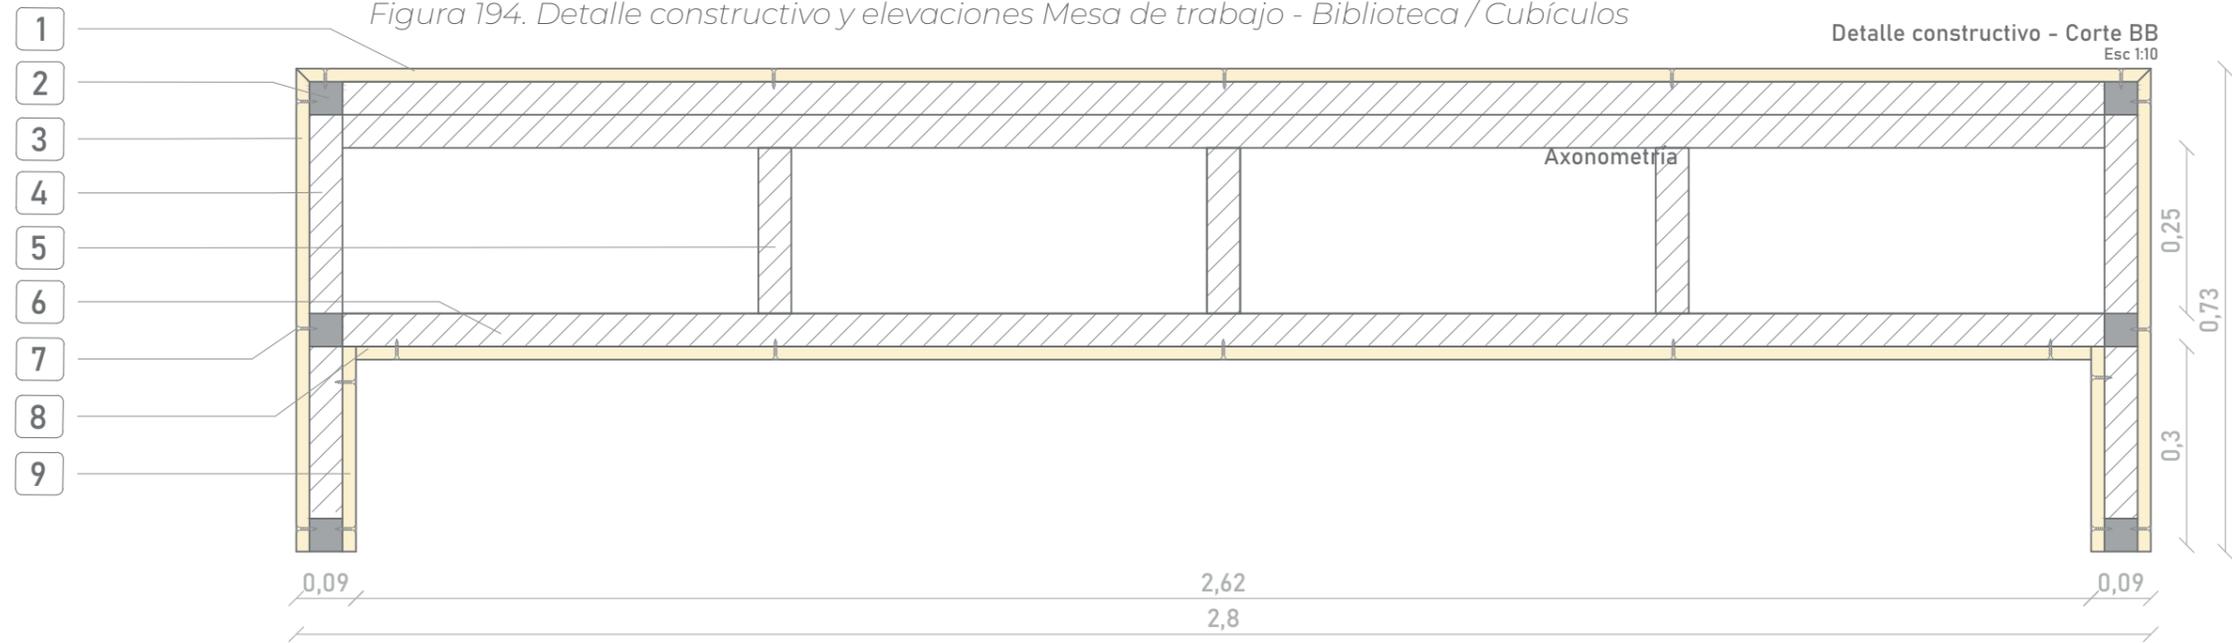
Detalle constructivo y elevaciones Mesa de trabajo - Biblioteca / Cubículos
